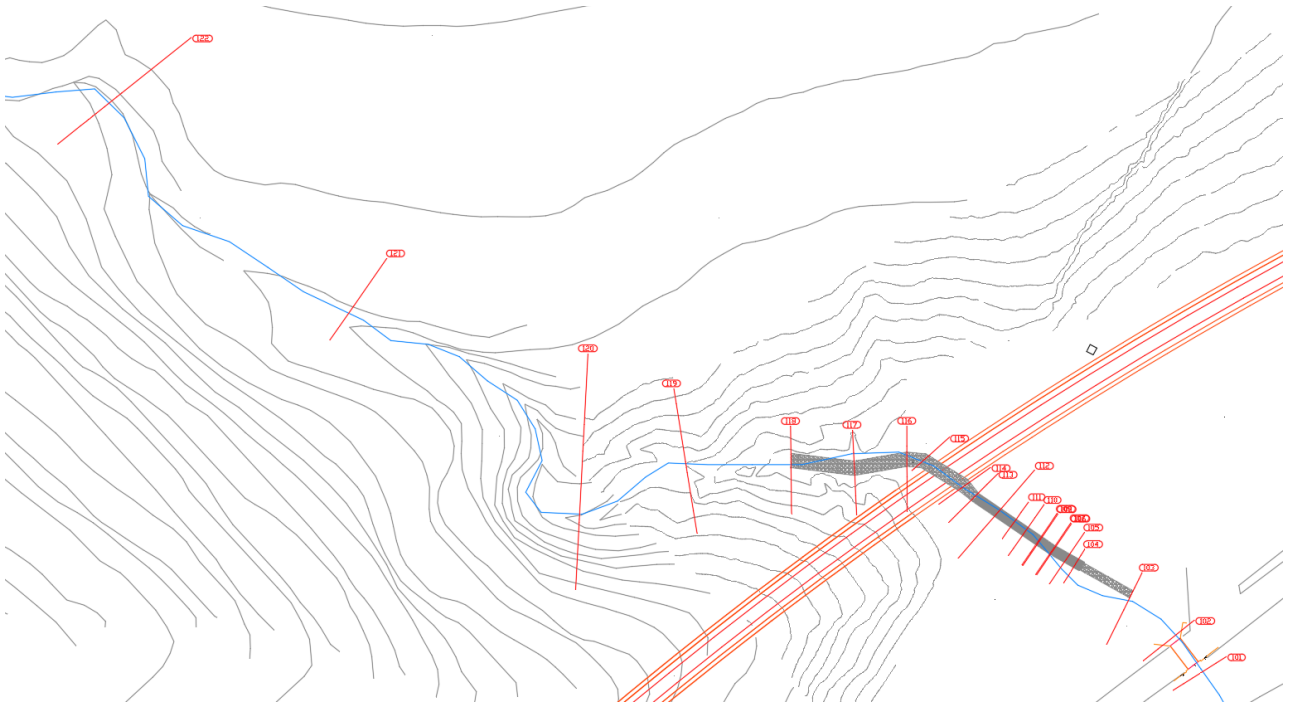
Schema planimetrico dell'asse IN04 e delle sezioni trasversali in condizioni Post Operam
